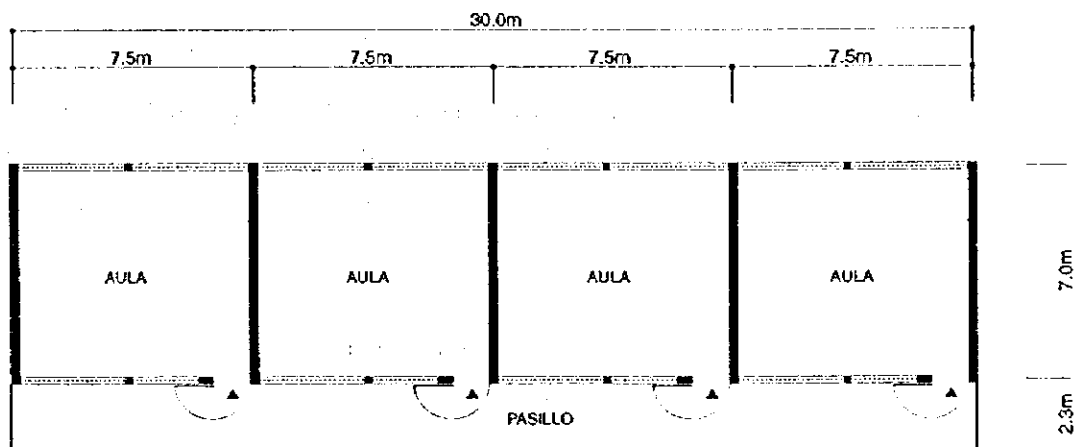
PLAN GENERAL DEL TIPO 4 DE EDUCACION MEDIA
